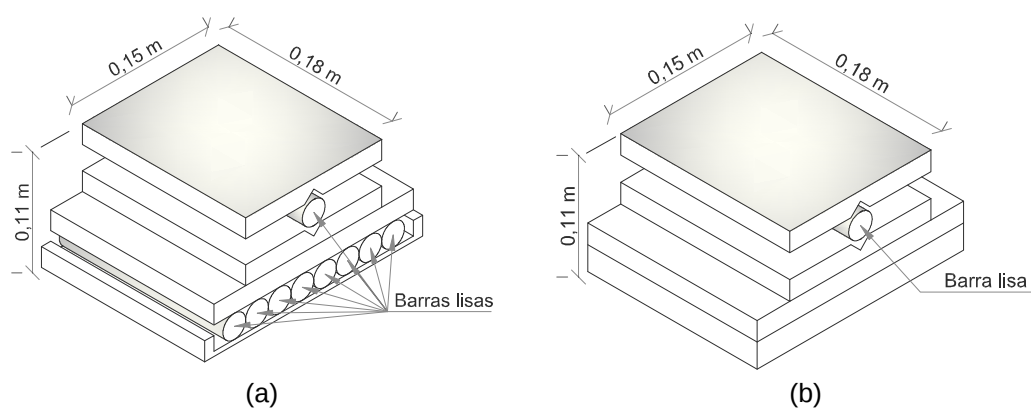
Apoios de viga, (a) primeiro gênero e (b) segundo gênero.
